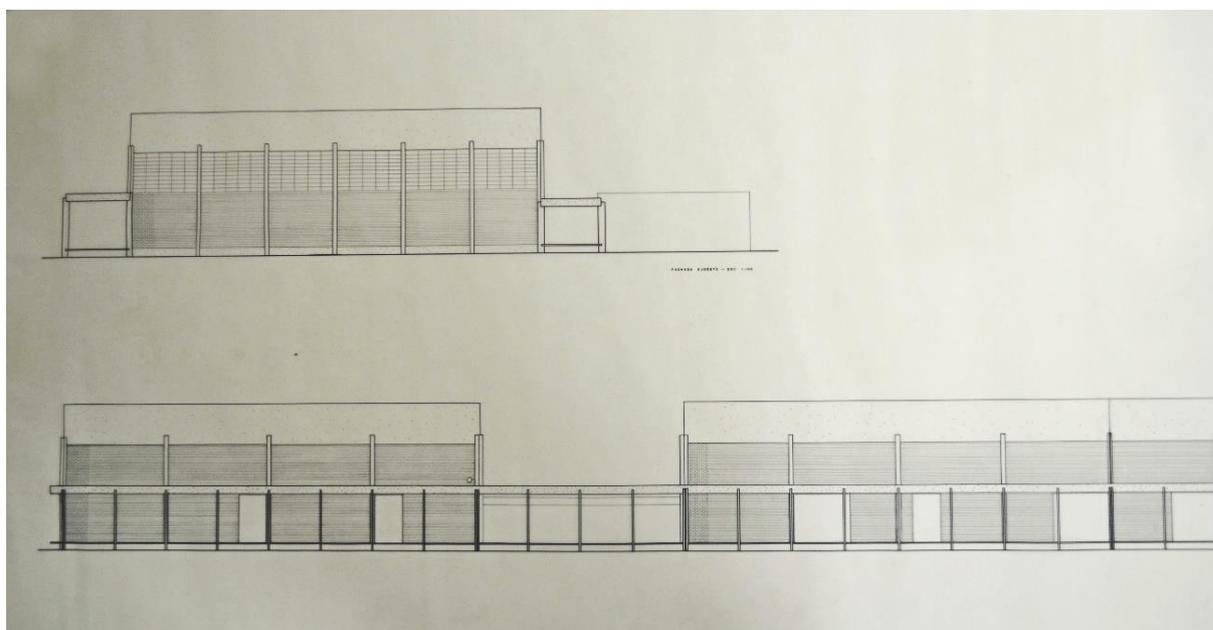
Fachadas do Setor E, destacando a malha estrutural externa em destaque e as passarelas de circulação em primeiro plano.
